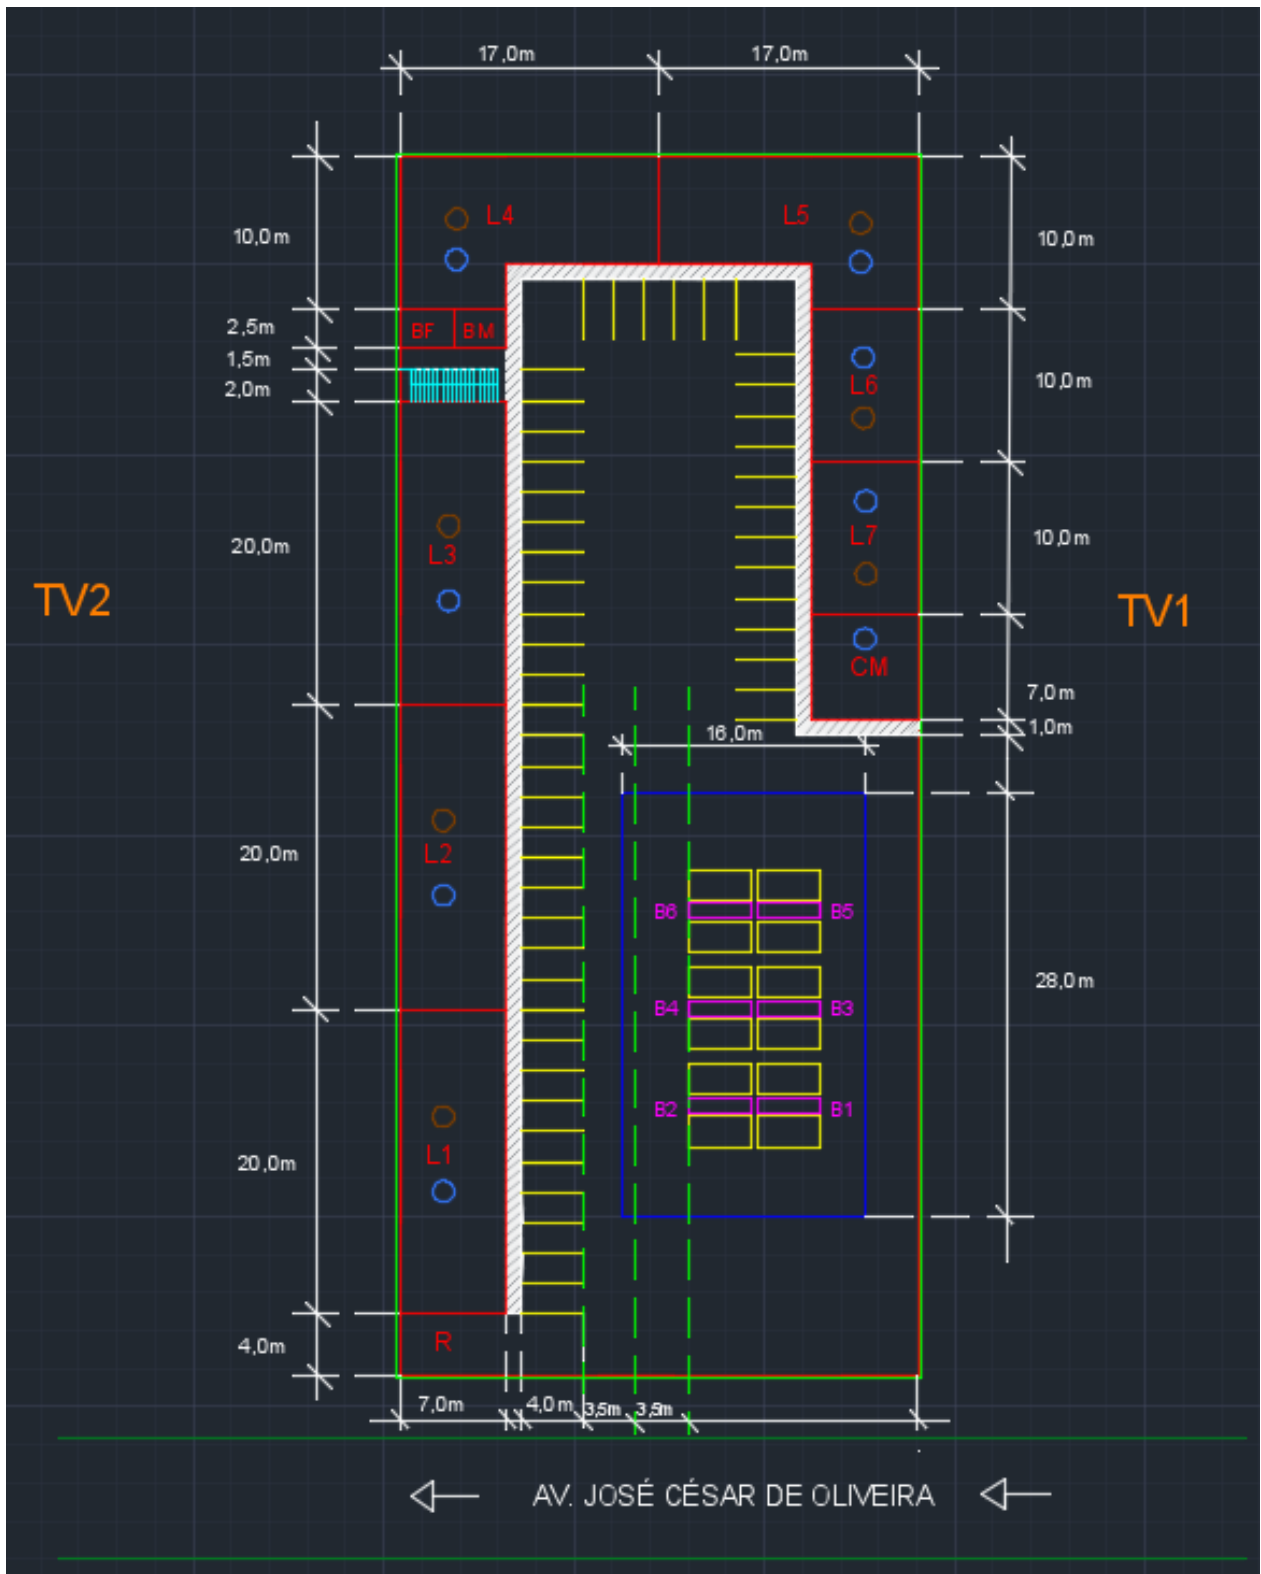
Planta do 1º pavimento do centro comercial (Autoria própria)
